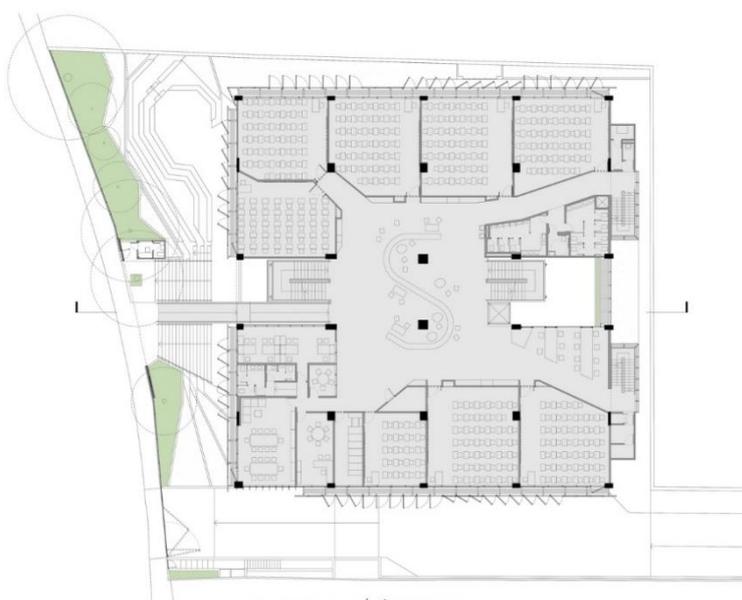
Planta Térreo Inferior da praça de chegada e refeitório da Fundação Bradesco.
